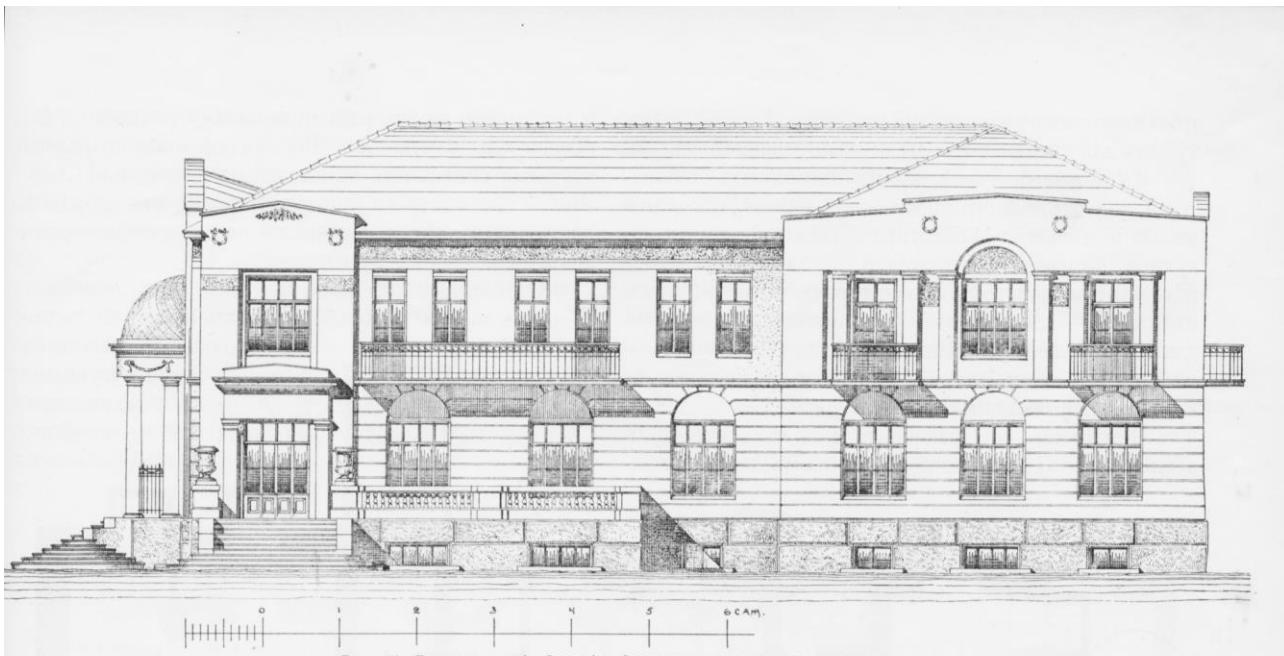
Главное зданіе Станції. Фасадъ къ лиману (по проекту).
